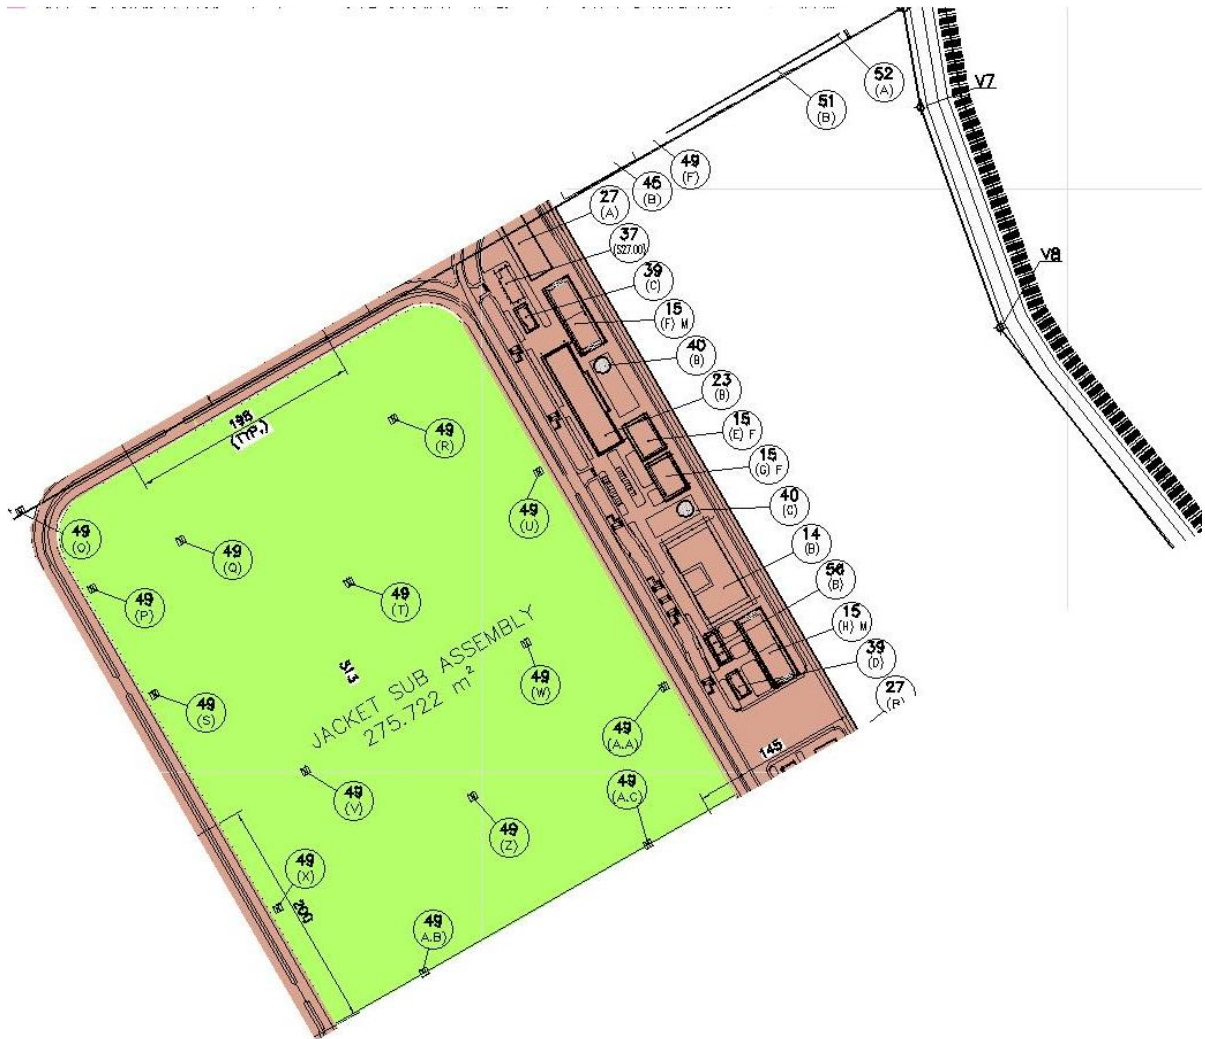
Planta de pavimentação da área de pré-montagem de jaquetas. Fonte: Projeto OSX
